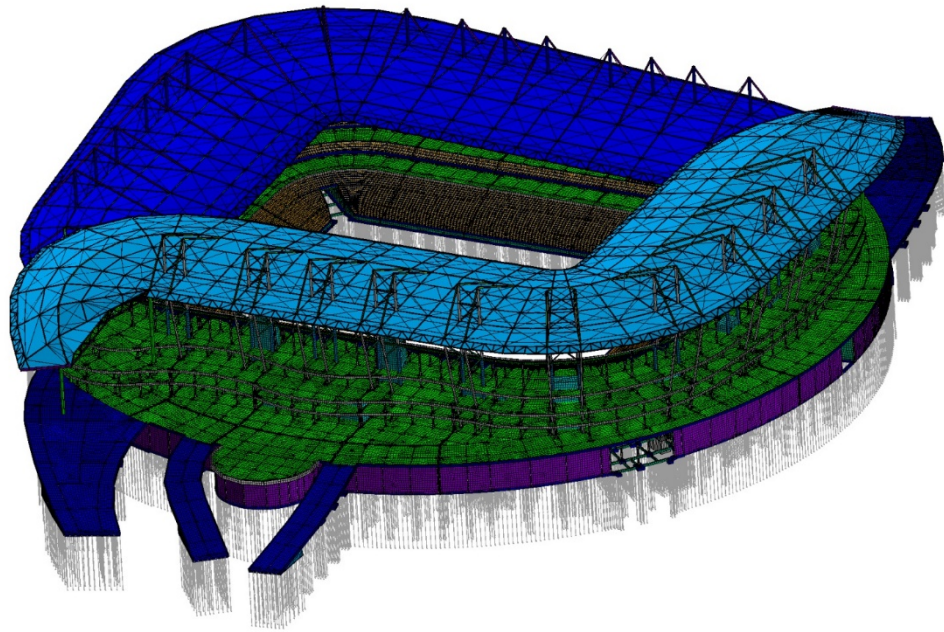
Конечноэлементная модель полной системы «основание – железобетонные конструкции фундаментов и трибун – металлические конструкции покрытия» стадиона в Ростове-на-Дону.
